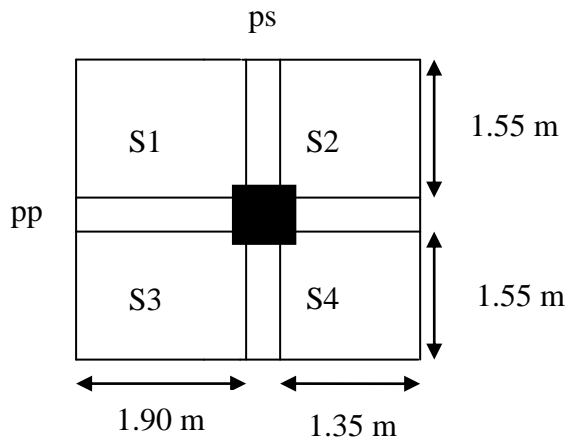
Surface afférente du poteau 2 (absence de l'escalier)
